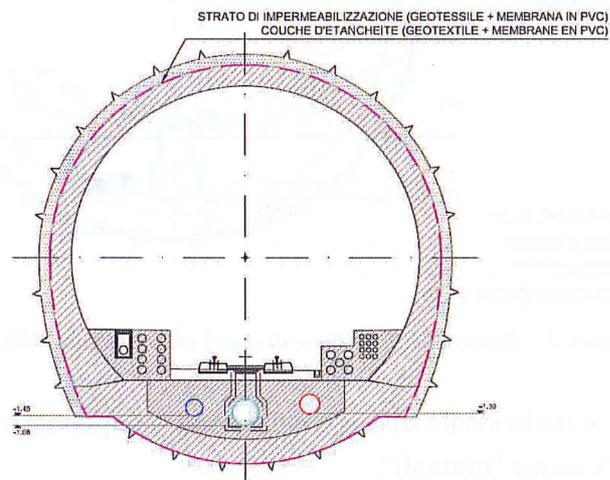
Impermeabilizzazione di tipo 3 per scavo tradizionale
